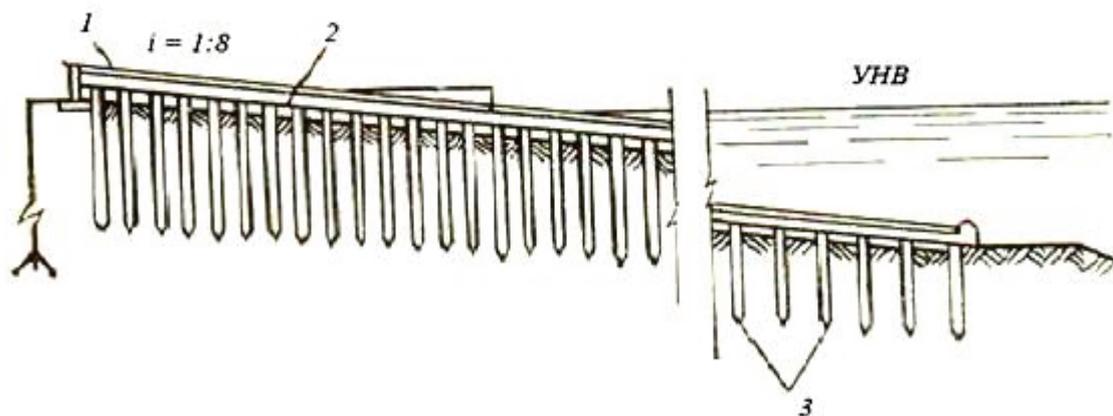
Неразрезные железобетонные балки на сваях (1 – рельс, 2 – железобетонные балки, 3 – сваи)
